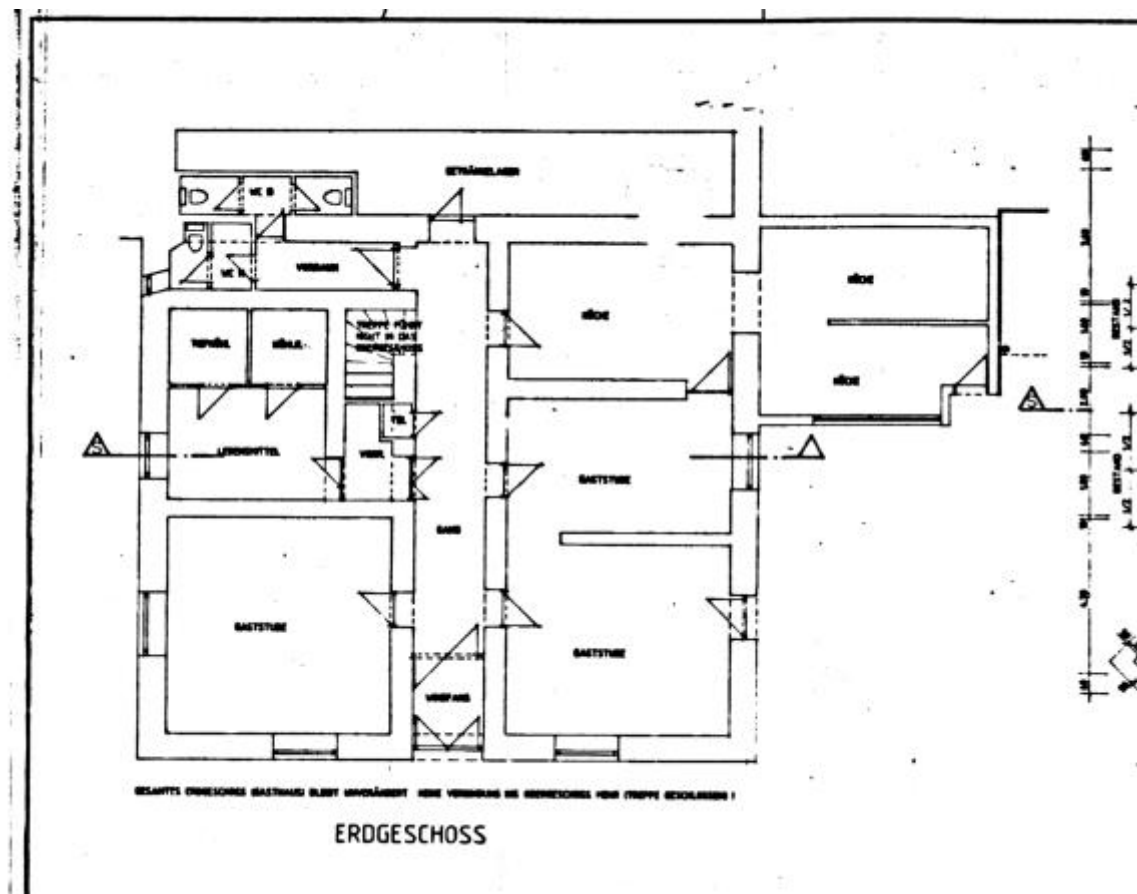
Grundriss Top 1 aus Einreichung Umbau 1992
